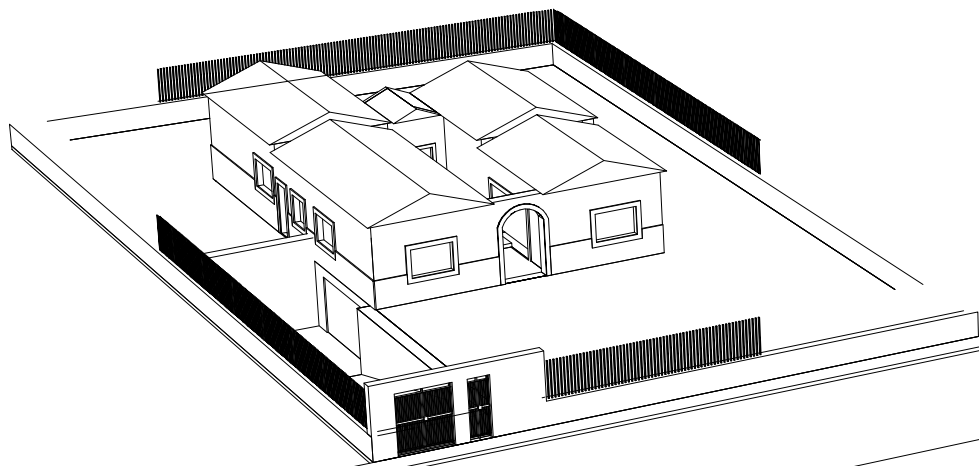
Vista tridimensionale della casa oggetto dello studio
